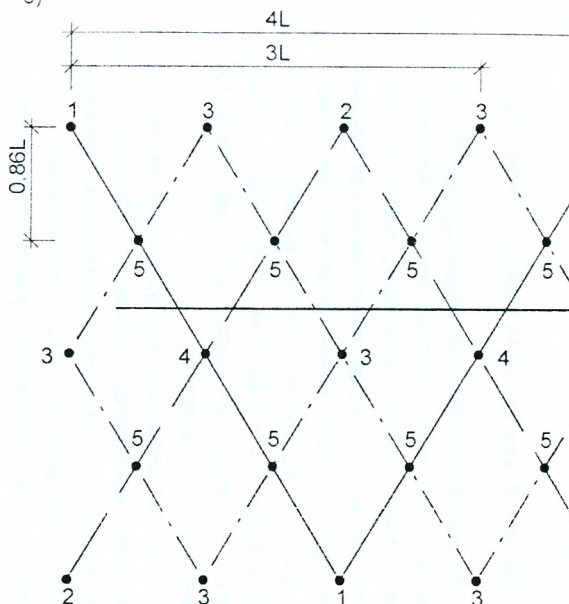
Многоэтапные схемы уплотнения грунтов:
